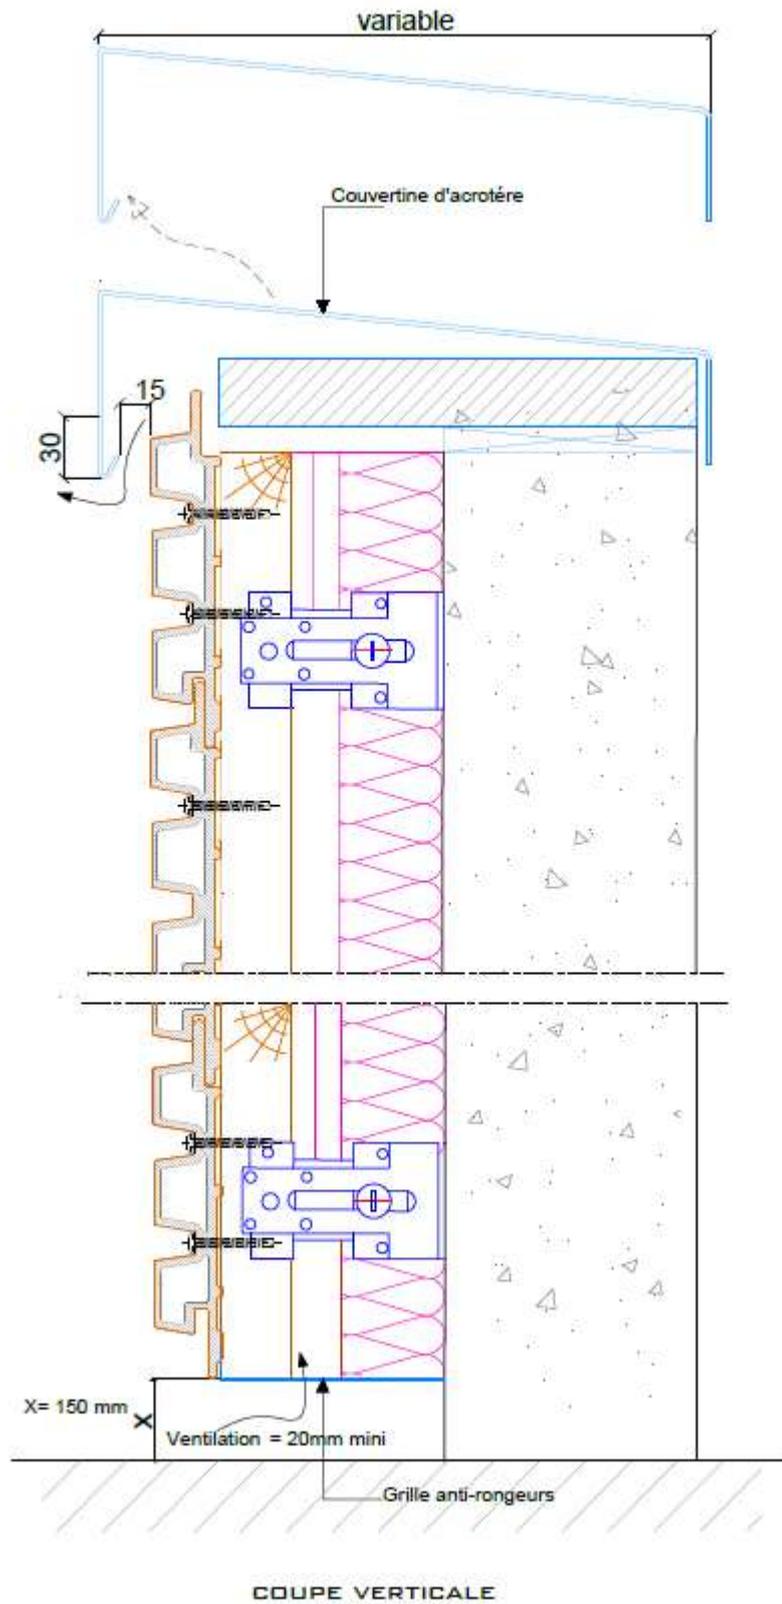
Coupe verticale : départ et arrêt haut bardage sur OB en pose horizontale
